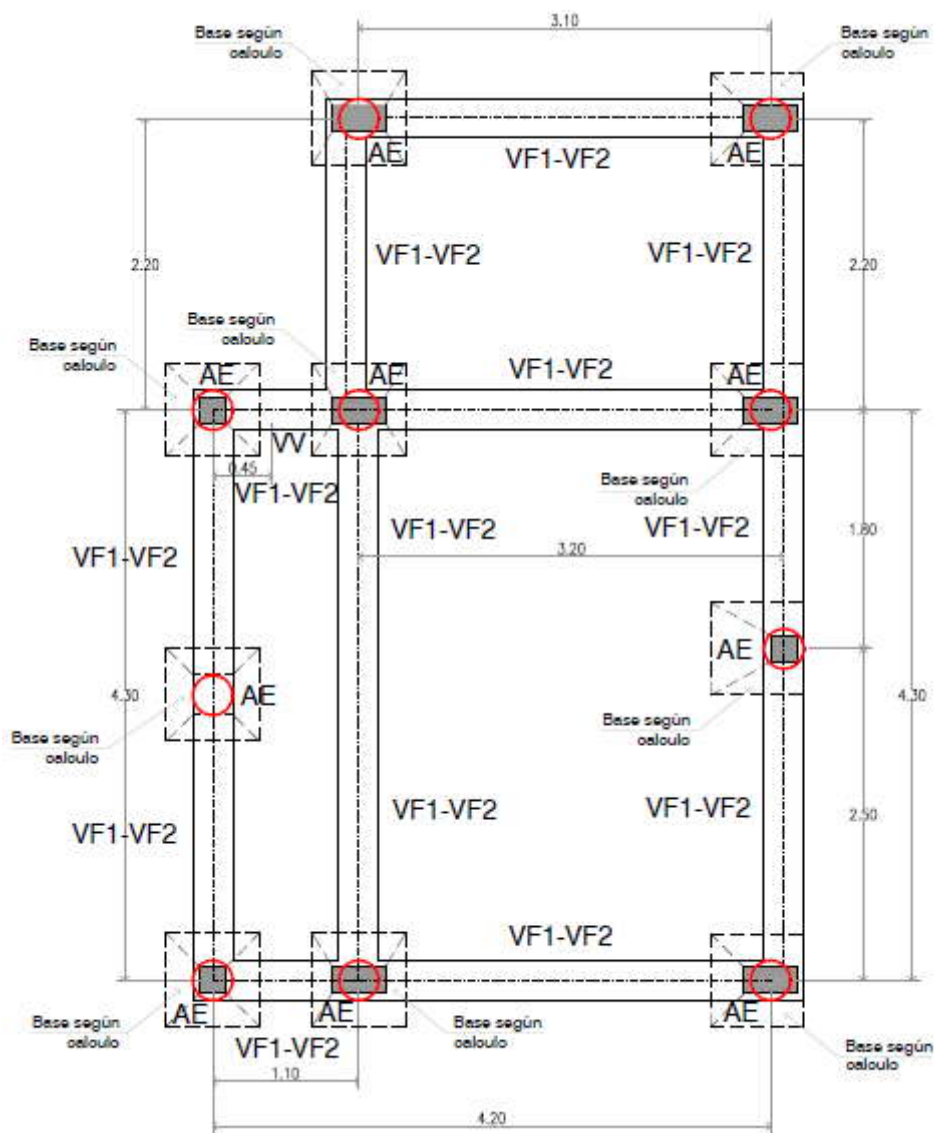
Planta fundación de la vivienda aislada de dos plantas
